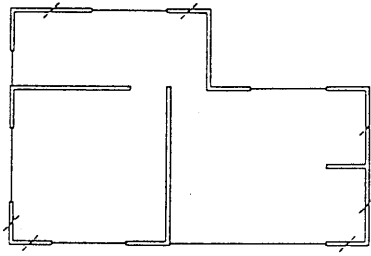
解析対象建築物平面図 (No.17, No.18)
